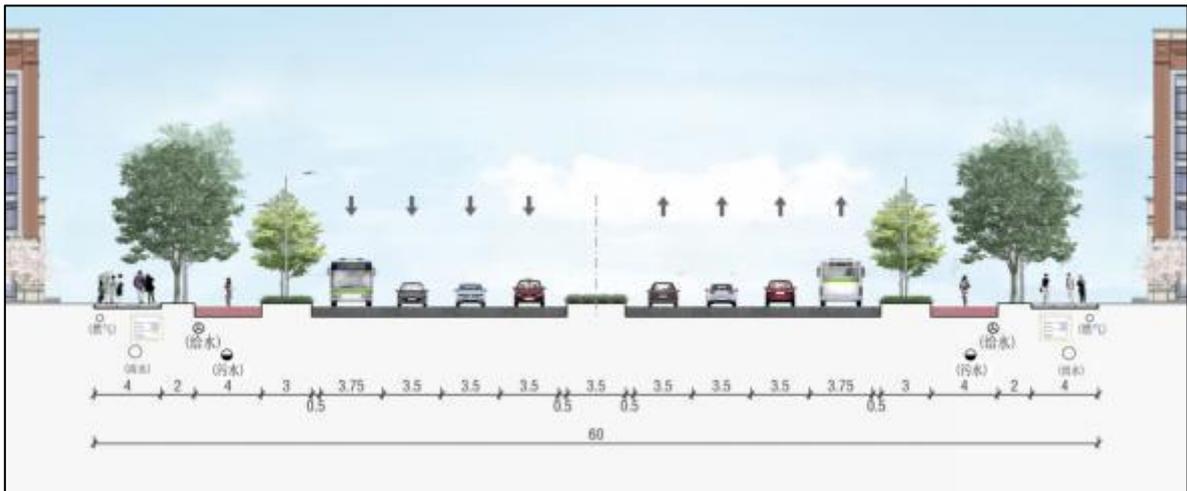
缆线管廊标准横断面布置图（双侧布置）
